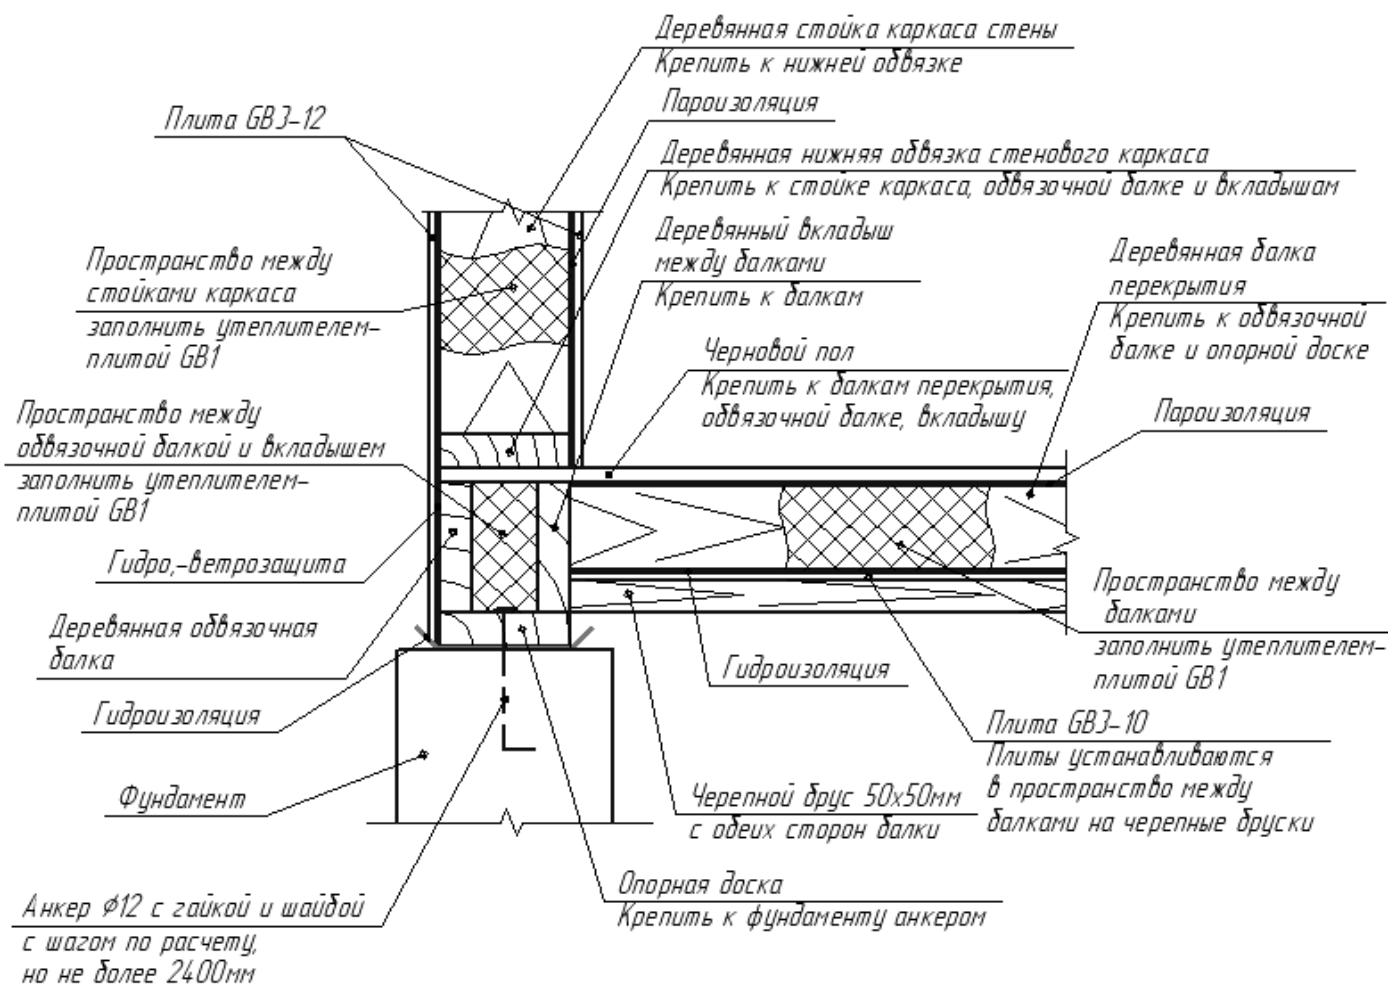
ОпираНИЕ балок перекрытия на опорную доску, уложенную на фундамент по наружным стенам
